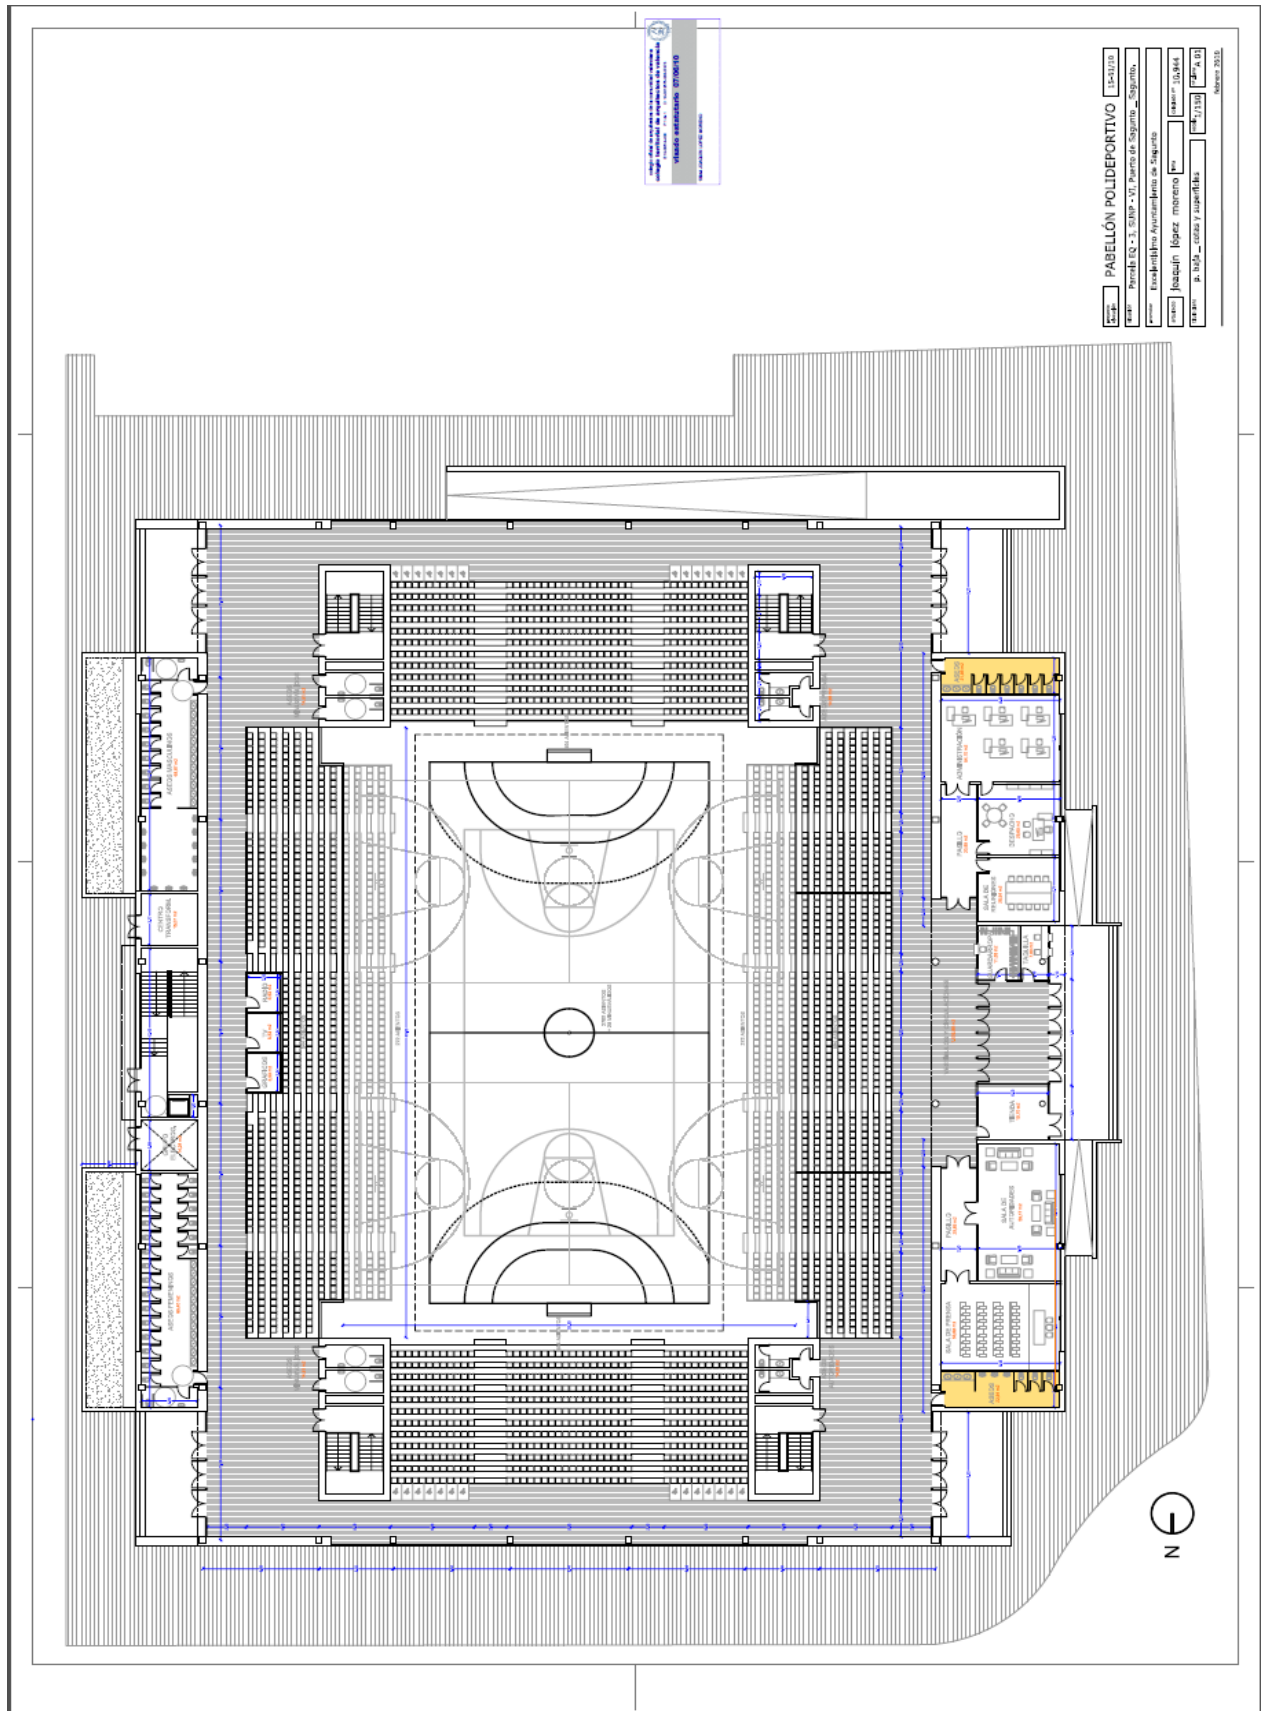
Plano planta baja Pabellón. Fuente: Proyecto de Ejecución.
